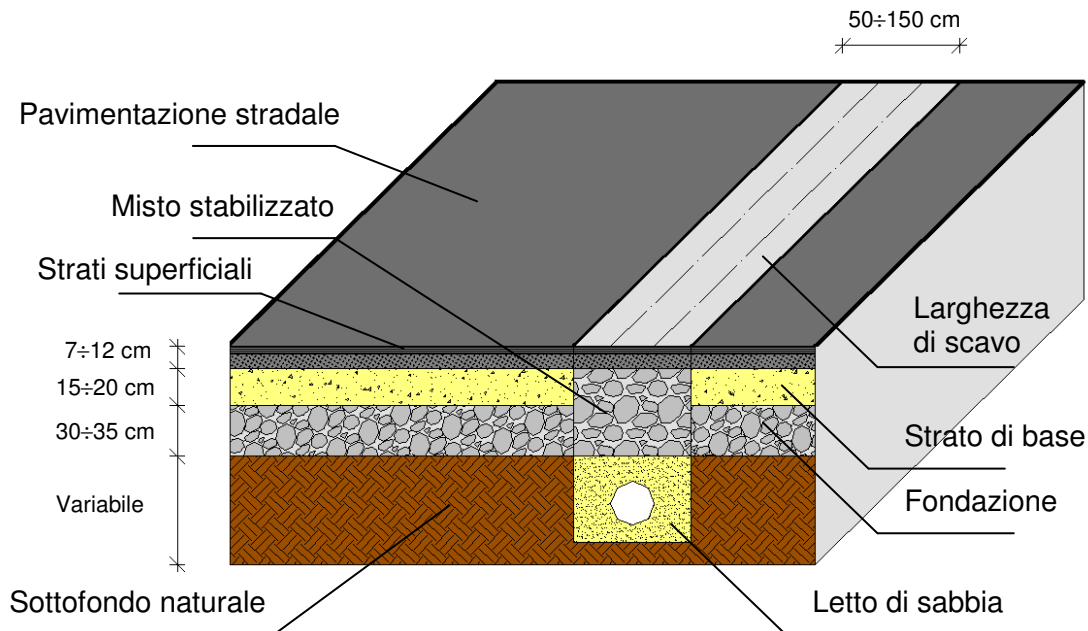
Schema tipo di pavimentazione e area di intervento
